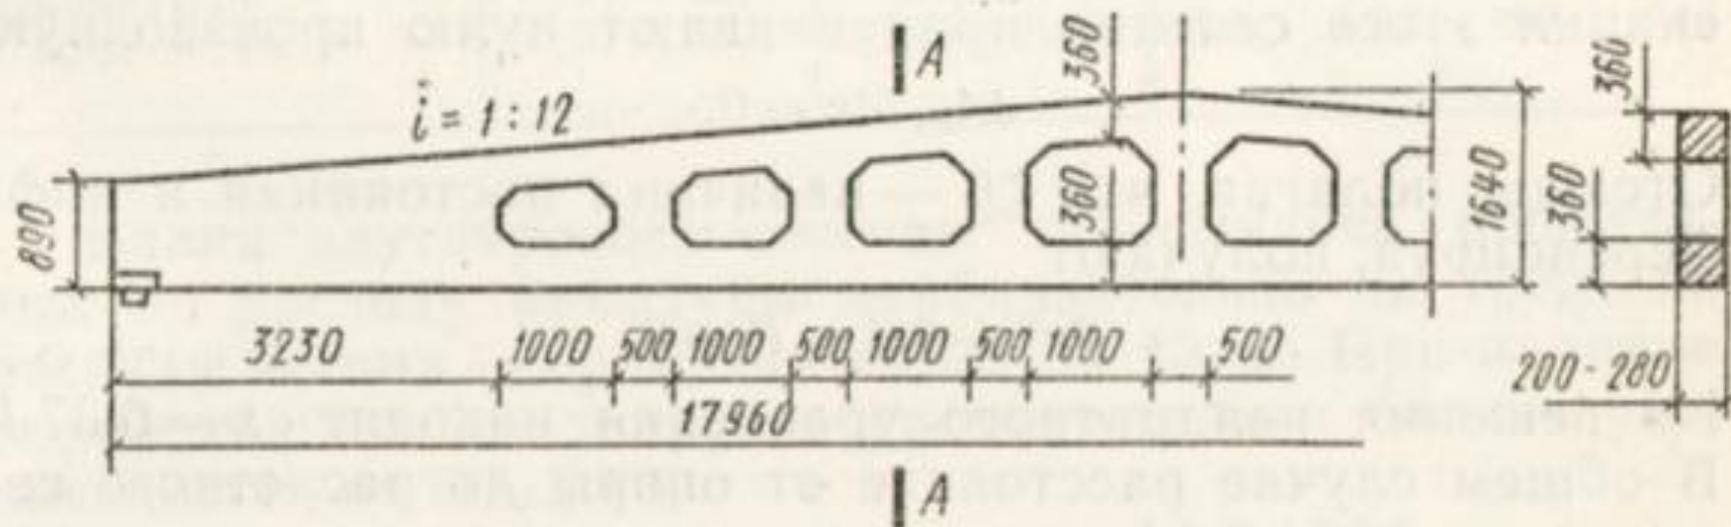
Двускатная решетчатая балка покрытия прямоугольного сечения пролетом 18 м
